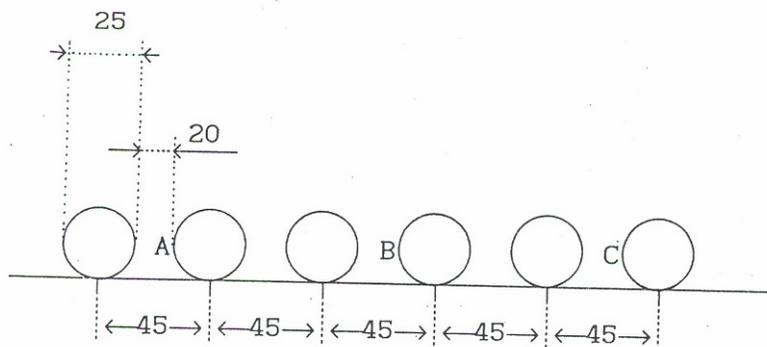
Arreglo de Cables para las Tres Fases de Alimentación
